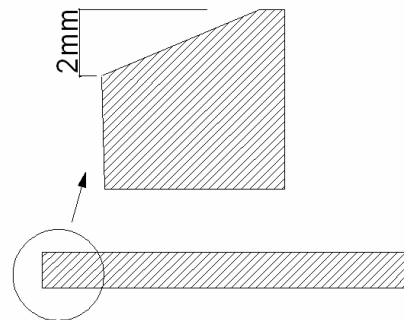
Tolérances dimensionnelles pour une dalle support d'une construction bois
